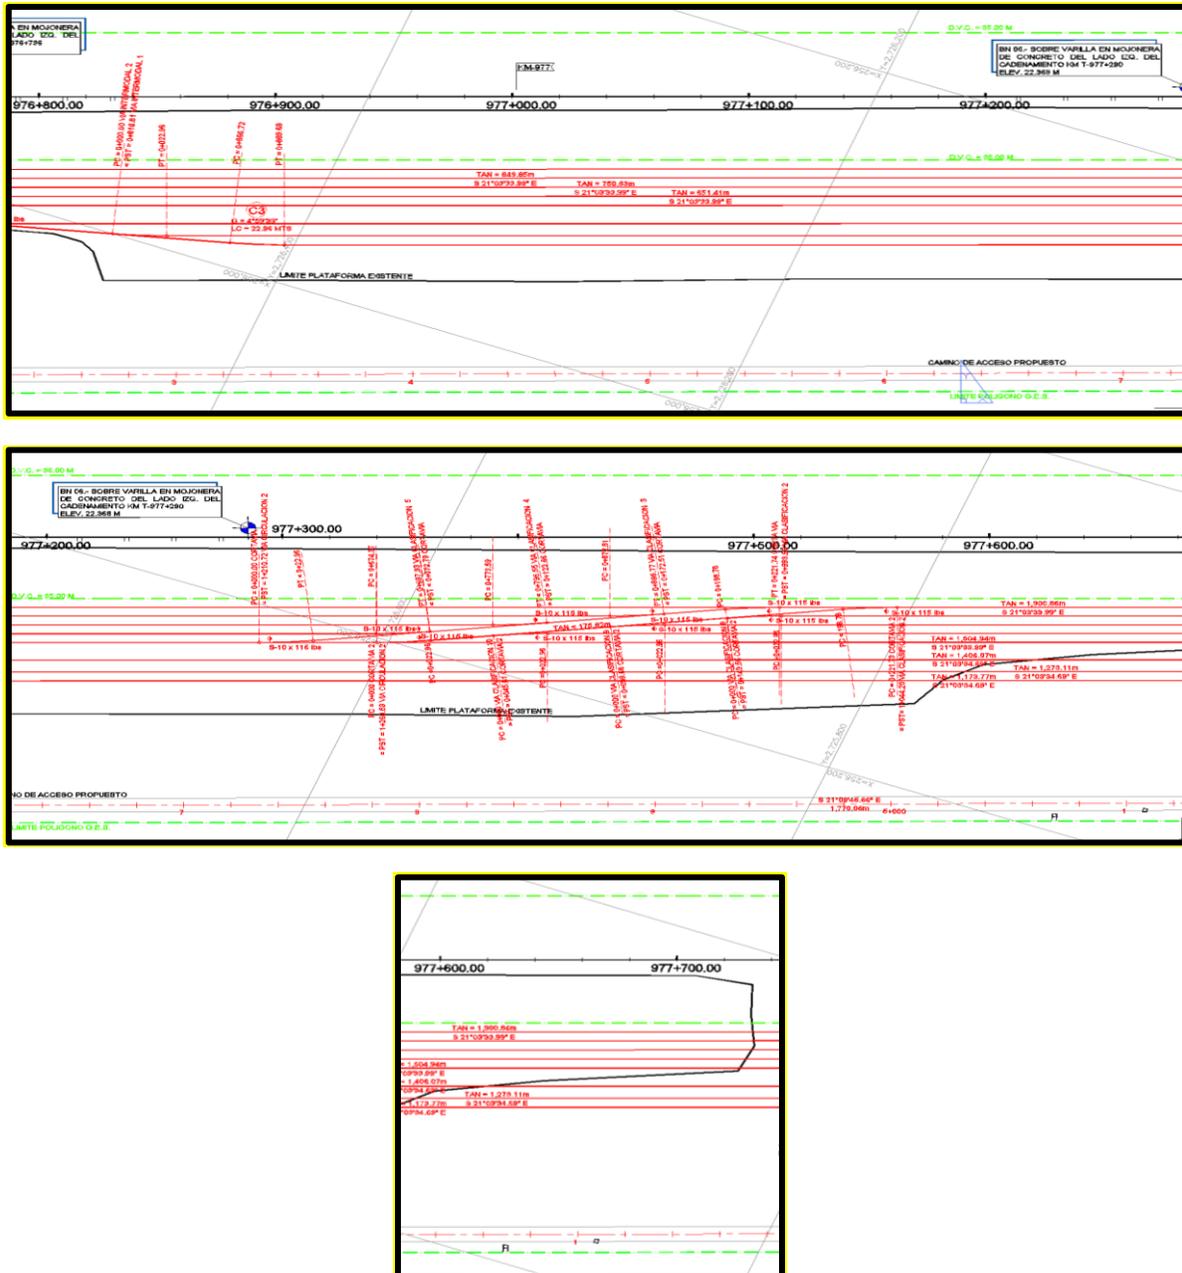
Imágenes de las vías férreas a construir en la Sección 2.
